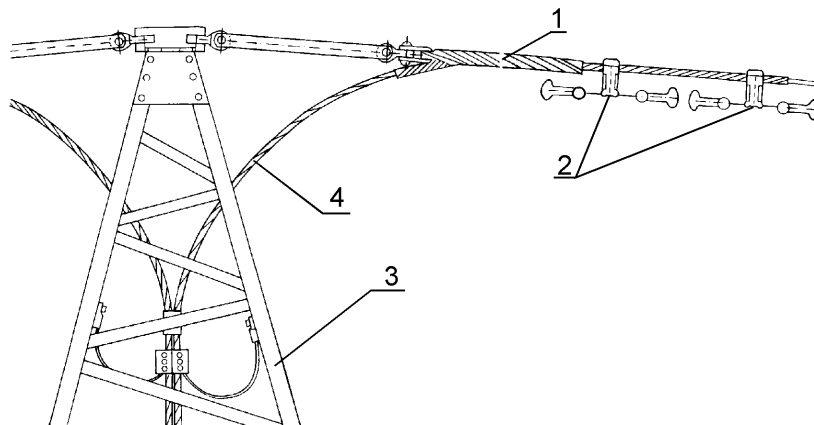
Кріплення ОК на металевій анкерній опорі: 1 – затискач натяжний; 2 – віброгасник; 3 – опора металева; 4 – ОК
